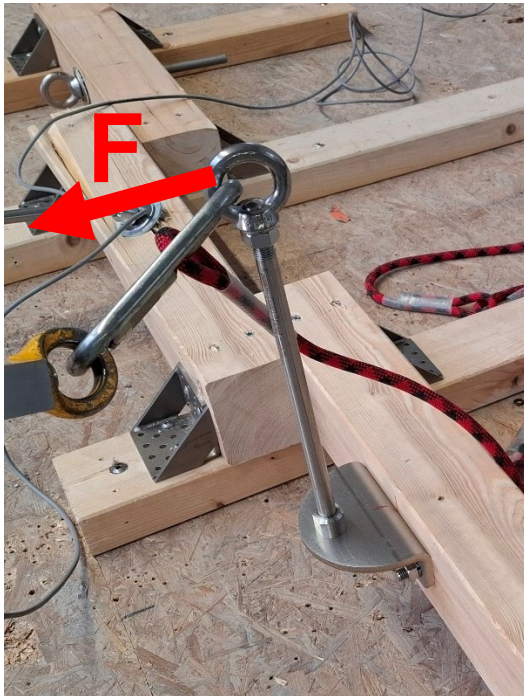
Prüfaufbau E, Anschlagereinrichtung,
